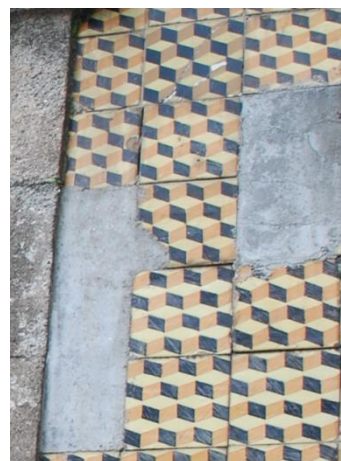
Preenchimentos de argamassa cimentícia¹²²
